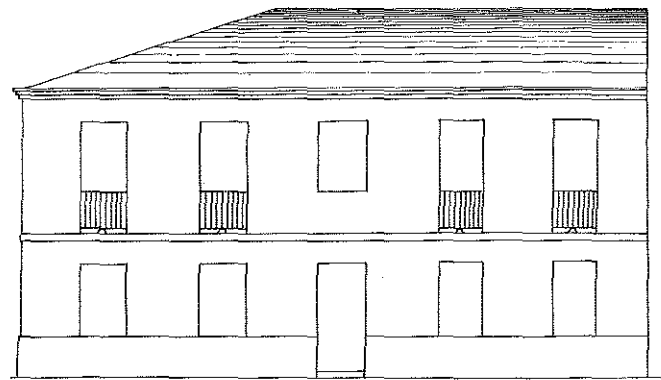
Proyecto de fachada para la casa de la Calle Capuchinos n° 1 (A.M.O. F-17, n° 29)
